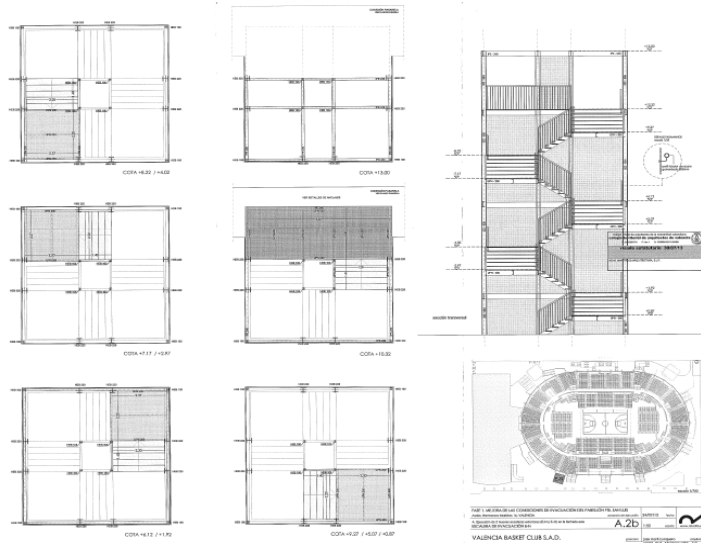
Plano de Situación Escalera E-O Exterior. Plano 23.
